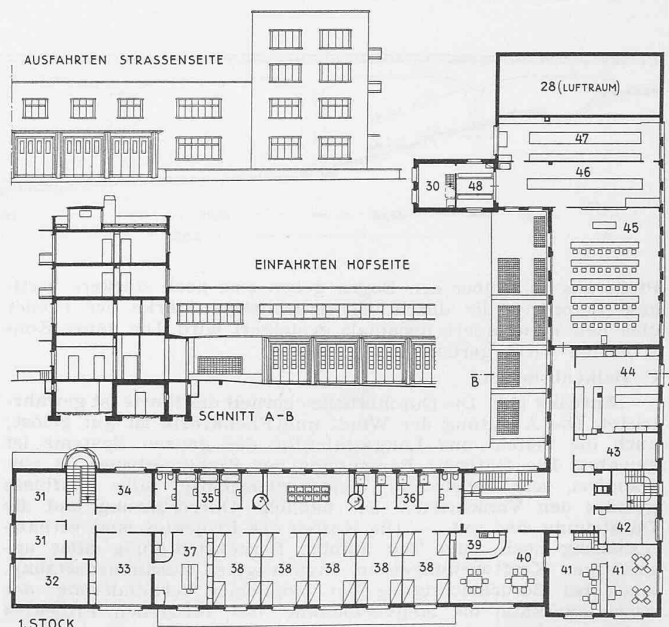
bis 6. Obergeschoss, Schnitt A-B und Fassaden. — 1:600.
